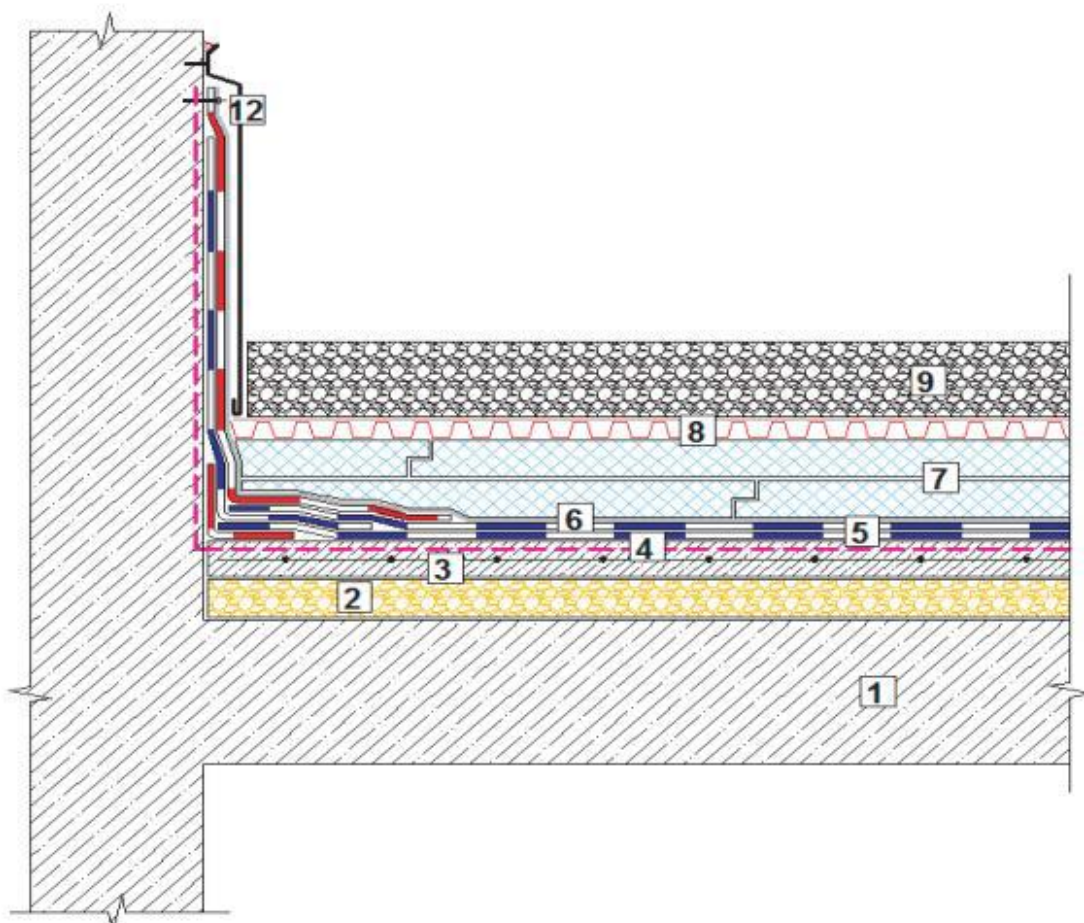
Примикання інверсійної покрівлі до парапету, де: 1 – з/б плита перекриття; 2 – схилоутворюючий шар із керамзитового гравію; 3 – армована цементно-пісчана стяжка; 4 – праймер бітумний; 5 – гідроізоляційний шар; 6 - голкопробивний геотекстиль 300 г/м²; 7 – екструзійний пінополістирол щільністю 35 кг/м³; 8 – дренажна мембрана; 9 – баласт; 12 – спецпланка із оцинкованої сталі
